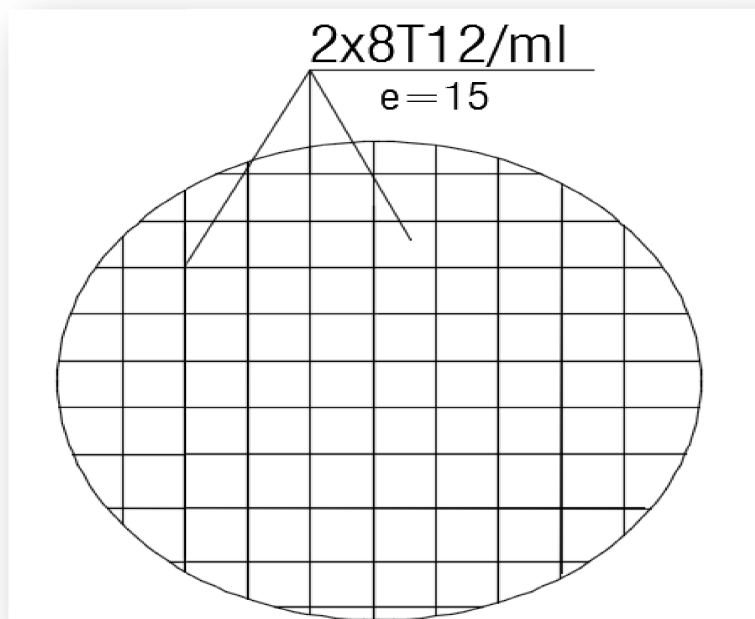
Ferrailage de la dalle pleine en travée et en appuis.
